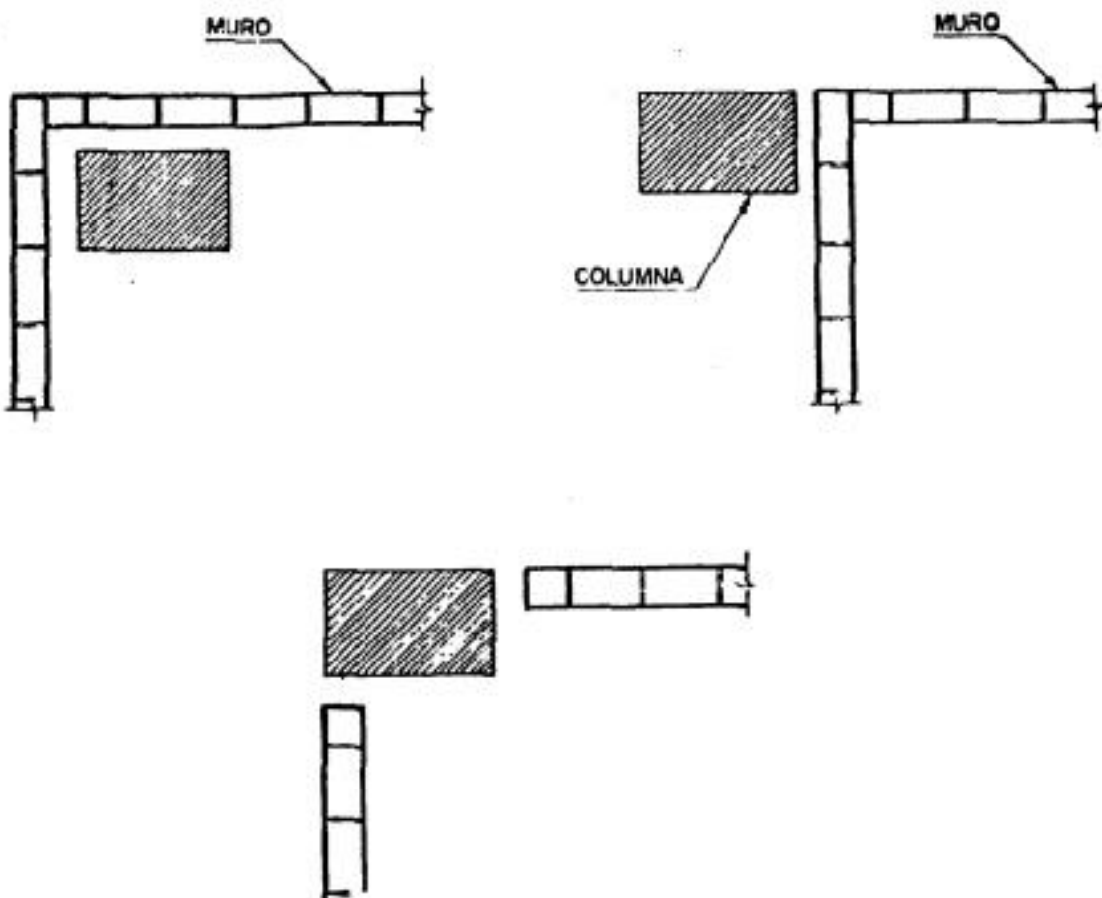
Alternativas para desligar los muros de la estructura en planta (ref. 16)
